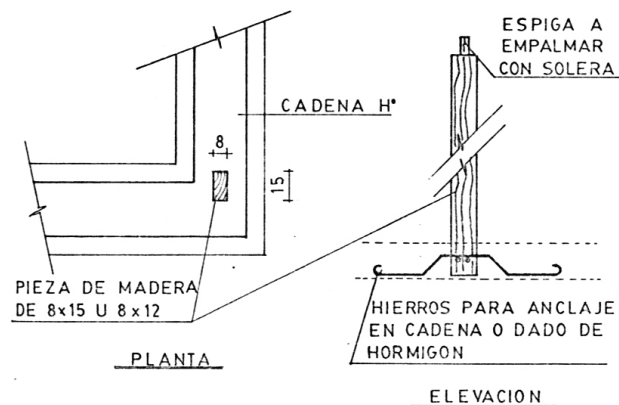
Ejemplo de refuerzo vertical de muro.
